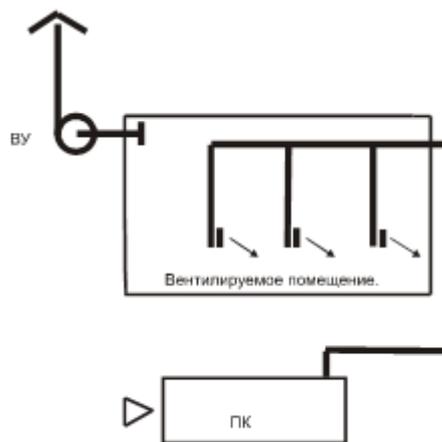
Приточная местная канальная вентиляция (воздушное душирование)
